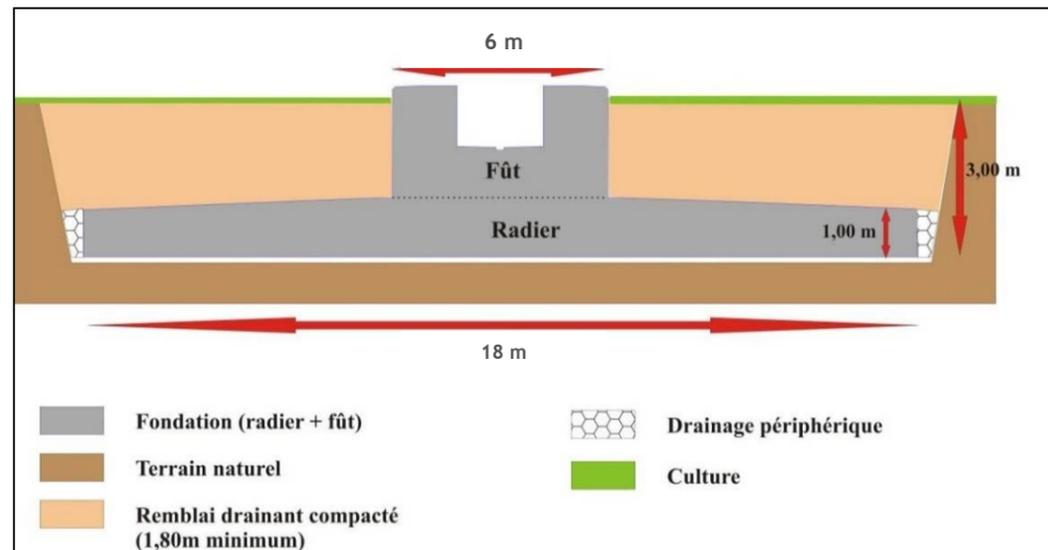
Exemple de coupe d'une fondation pour une éolienne
